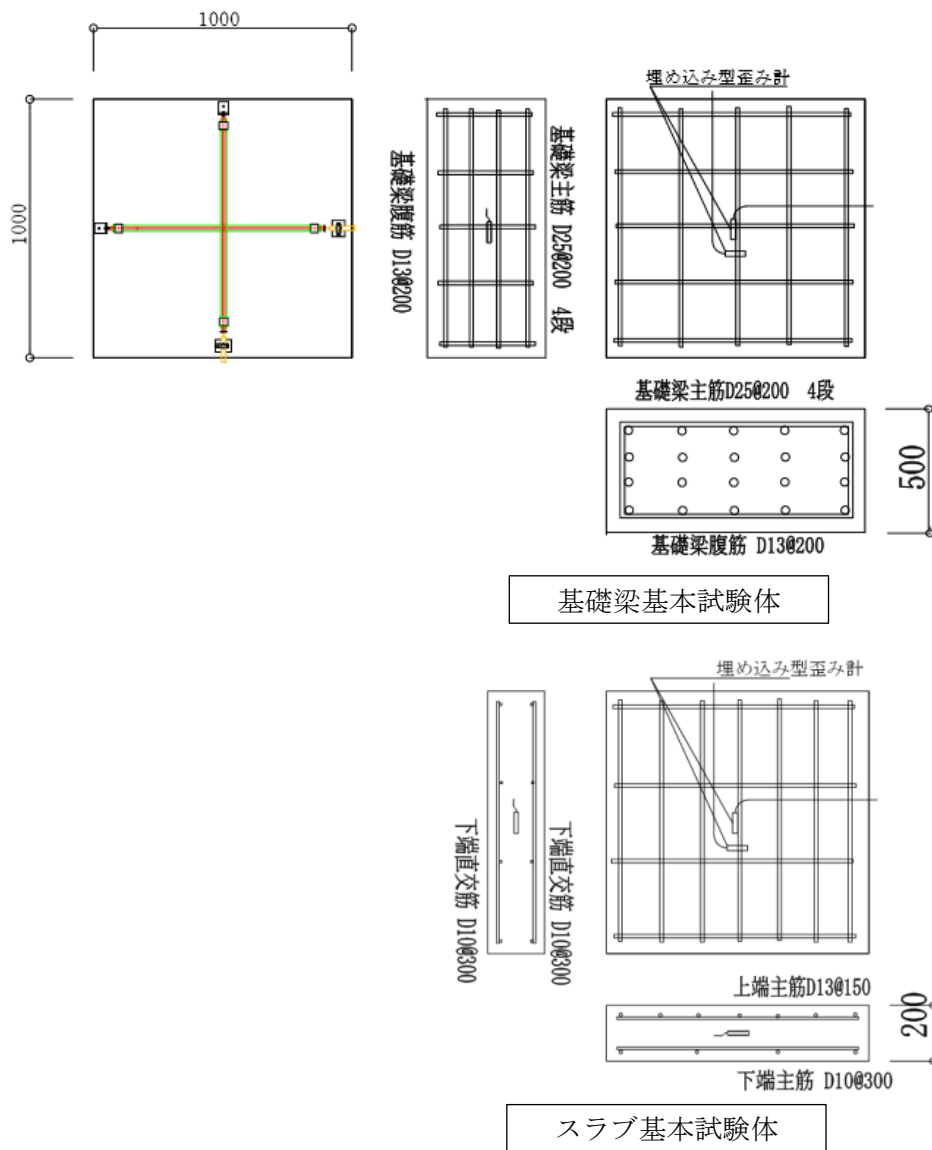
スラブおよび基礎梁基本試験体形状・断面
